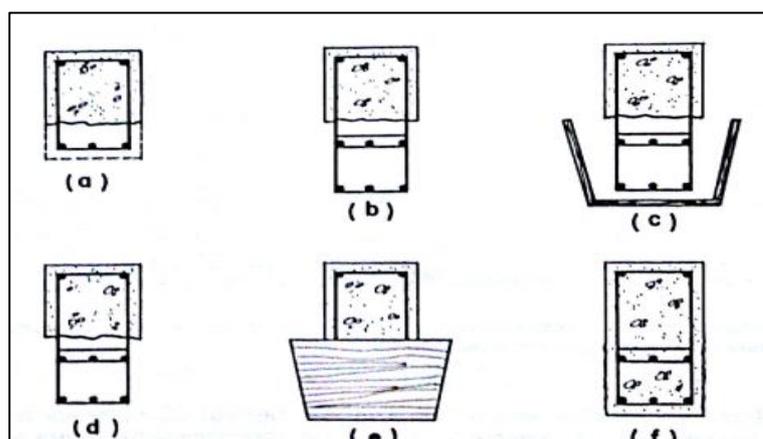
Reforço de vigas com concreto e armaduras suplementares.
